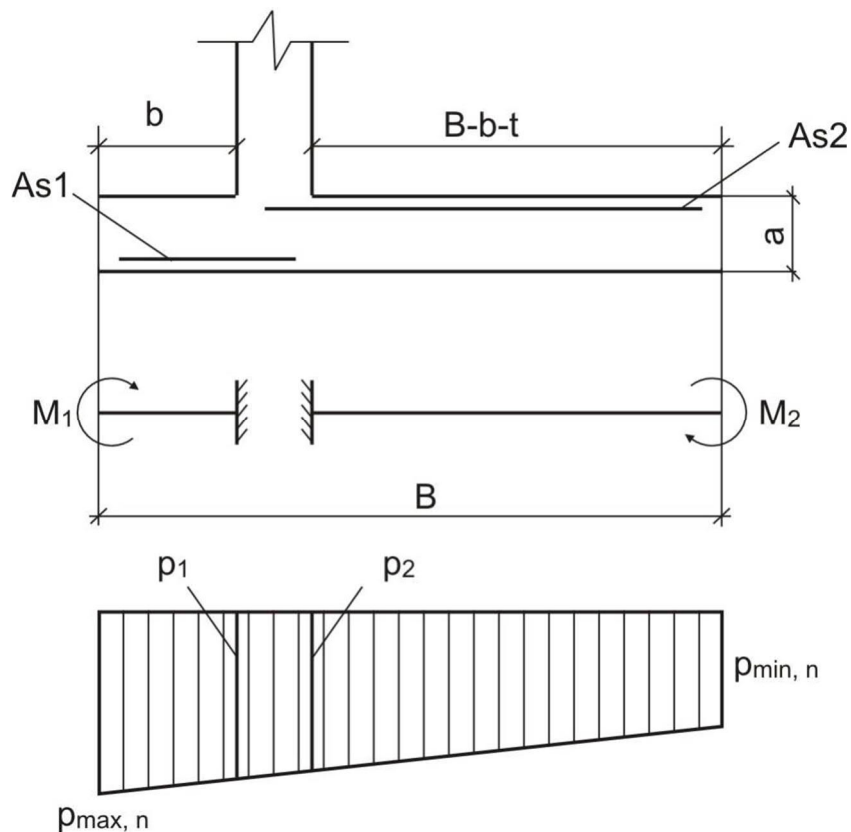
До розрахунку фундаментної плити [10, с. 11, рис. 3]
